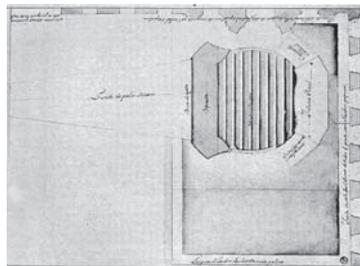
BNL, D.389-108V. Planta de Estudo da Casa da Ópera/Teatro de Queluz.
